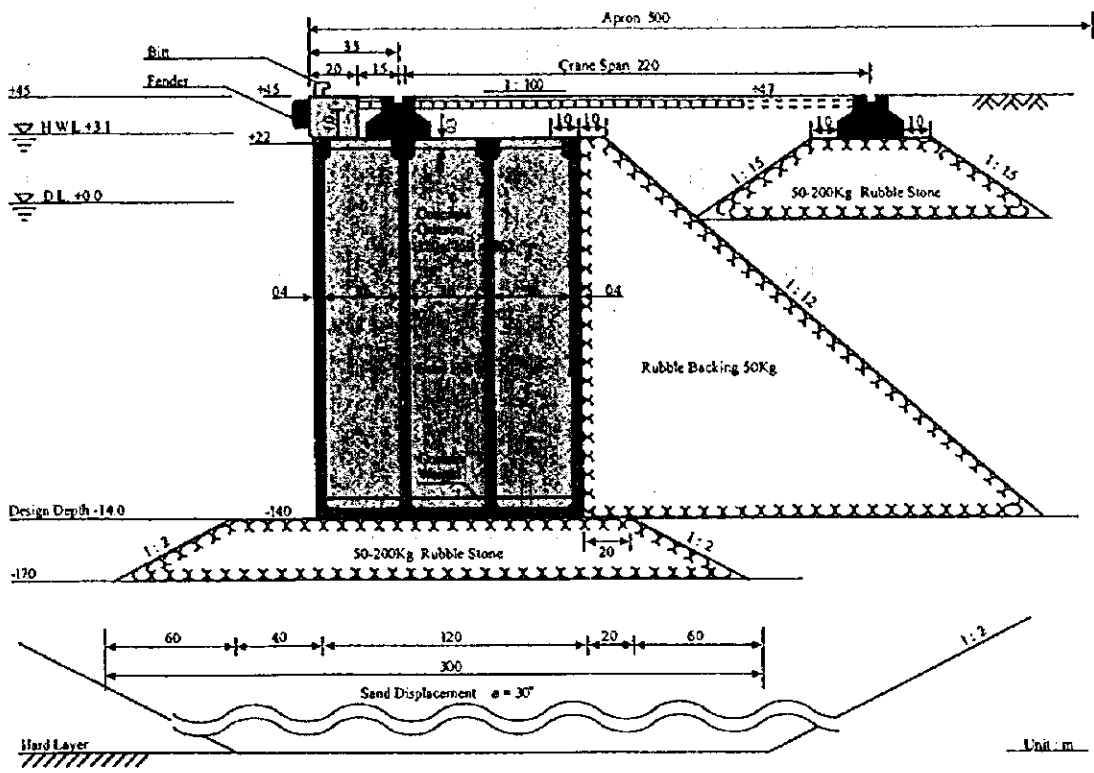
Atracadero de Contenedores/ Atracadero para Carga a granel tipo Campana Neumática de Hormigón (-14m)
